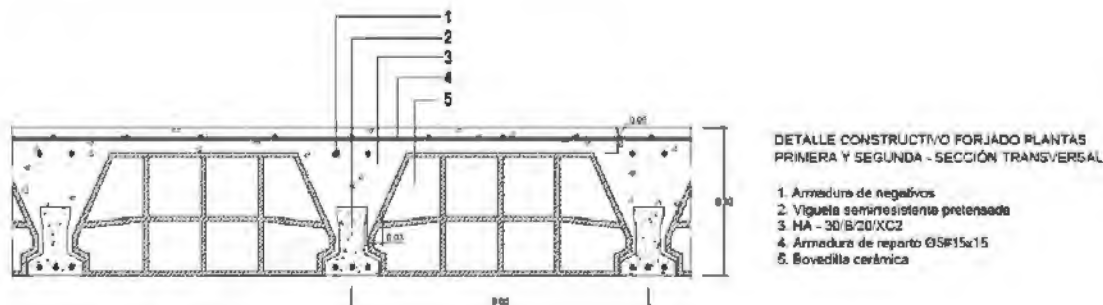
Detalle constructivo forjado – sección transversal. Fuente: propia
